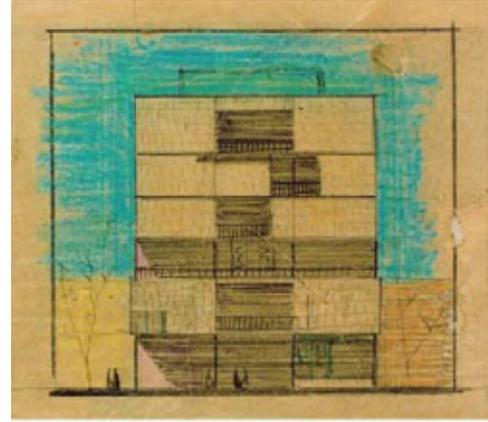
Dibujo original de alzado y planta presentados a concurso. Fundación Alejandro de la Sota.
